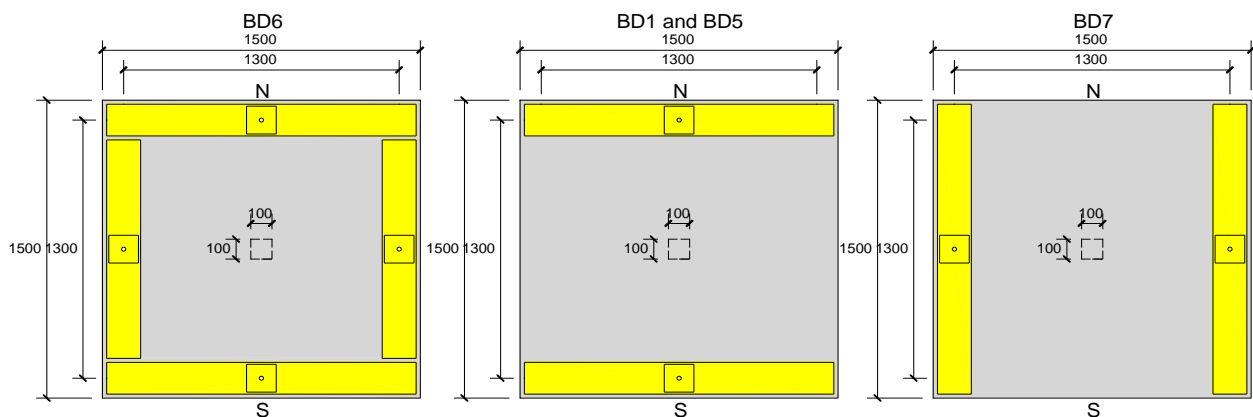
Vista em planta dos modelos BD [mm]. Regan [6]
